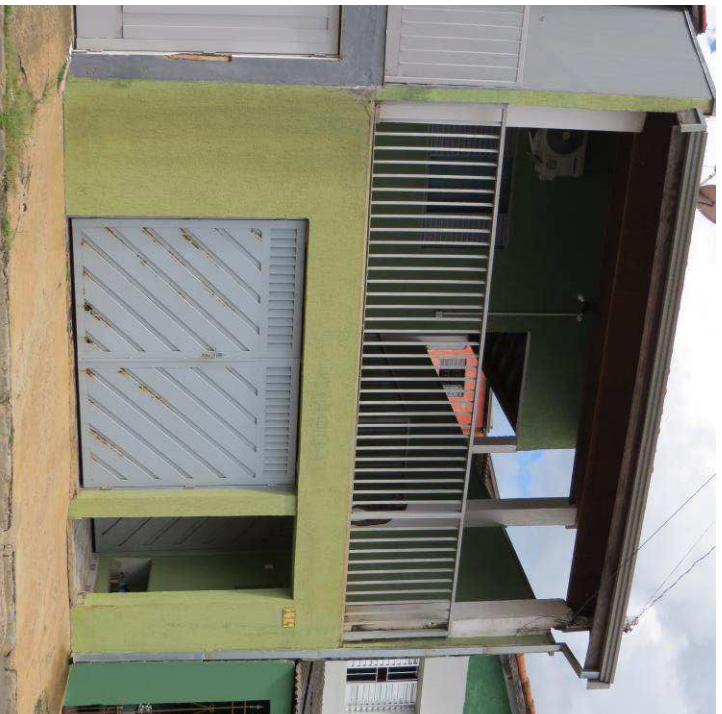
VISTA EXTERNA DO IMÓVEL – DETALHE DO PAVIMENTO SUPERIOR
